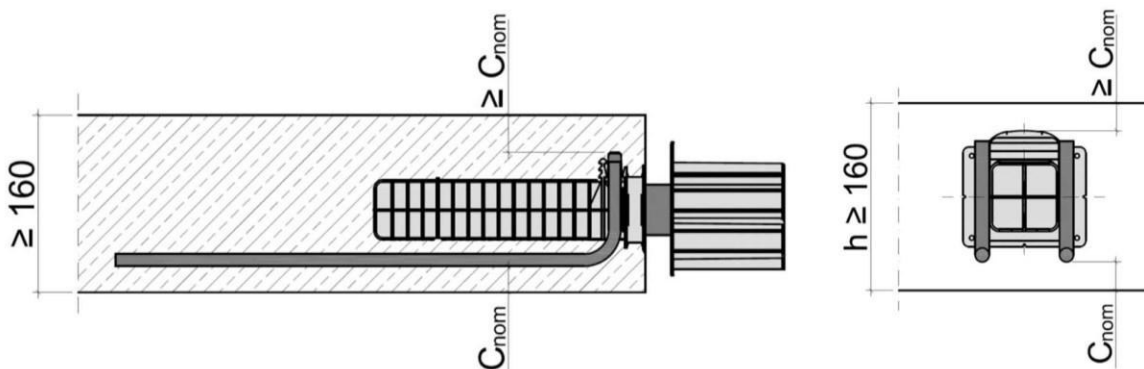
Betonüberdeckung Schöck Tronsole® Typ P (Quelle: Z-15.7-349 [14])
